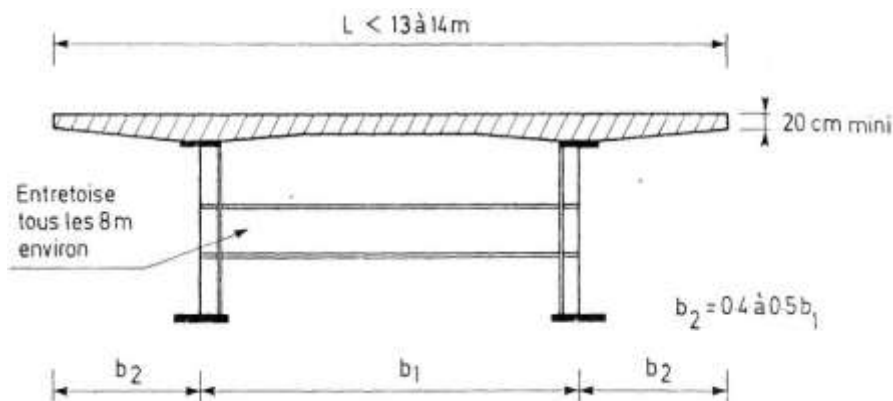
Coupe transversale d'un tablier Bipoutre mixte avec entretoise
